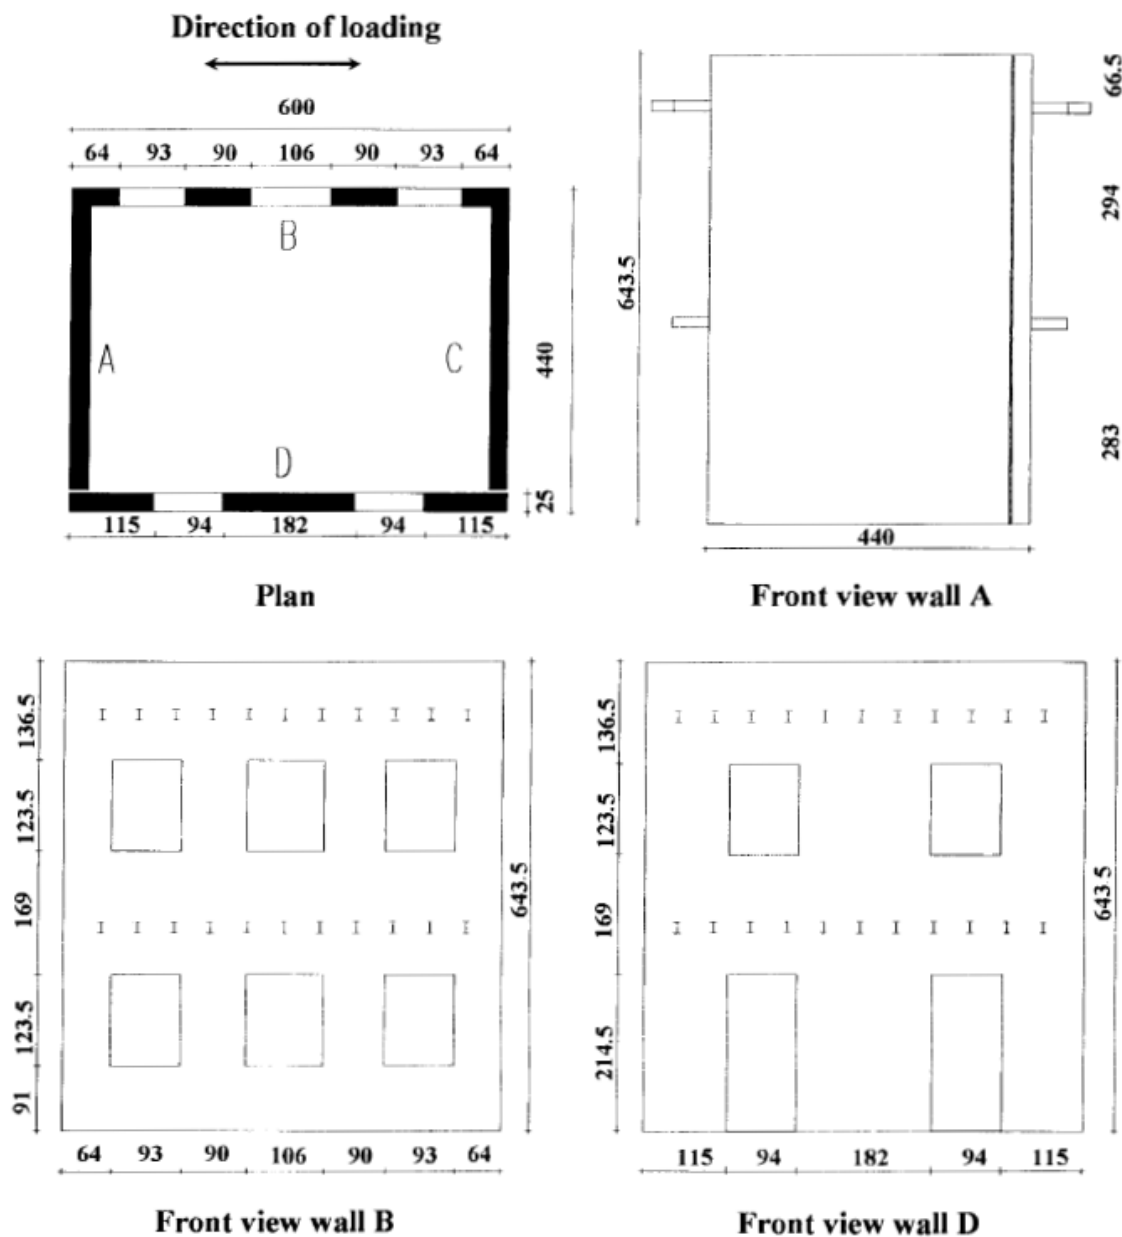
Plans de la structure-test et de ses différentes parois (dimensions en cm)
